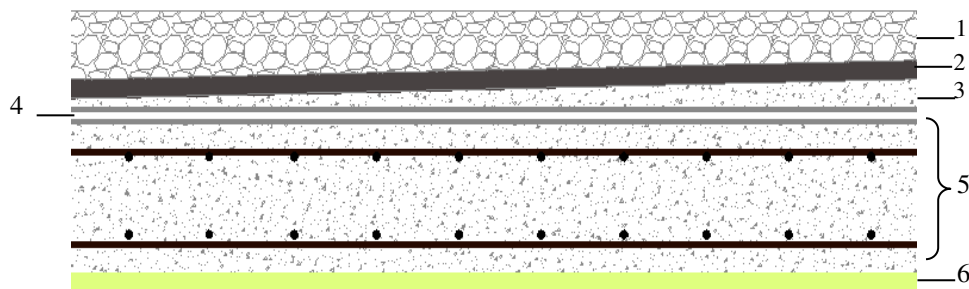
Composants d'un plancher terrasse en corps creux.
